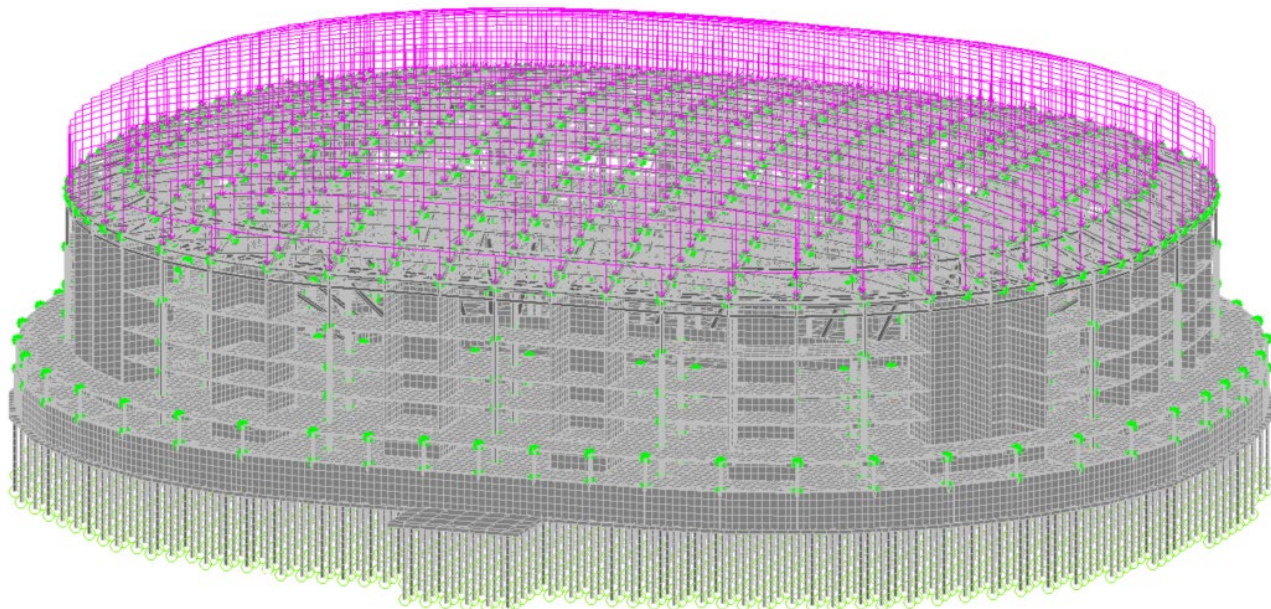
Схема приложения нагрузки от неэксплуатируемой кровли
